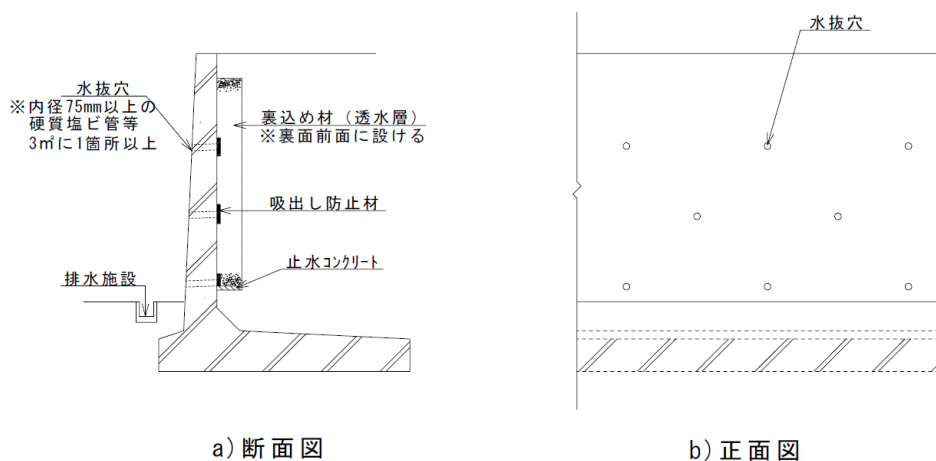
鉄筋コンクリート造擁壁の水抜穴の施工例
